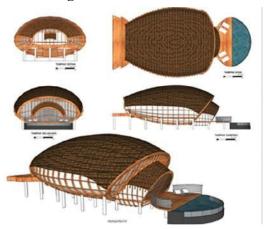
Gambar denah, potongan dan perspektif bangunan restauran Sumber : Analisa Penulis, 2020
